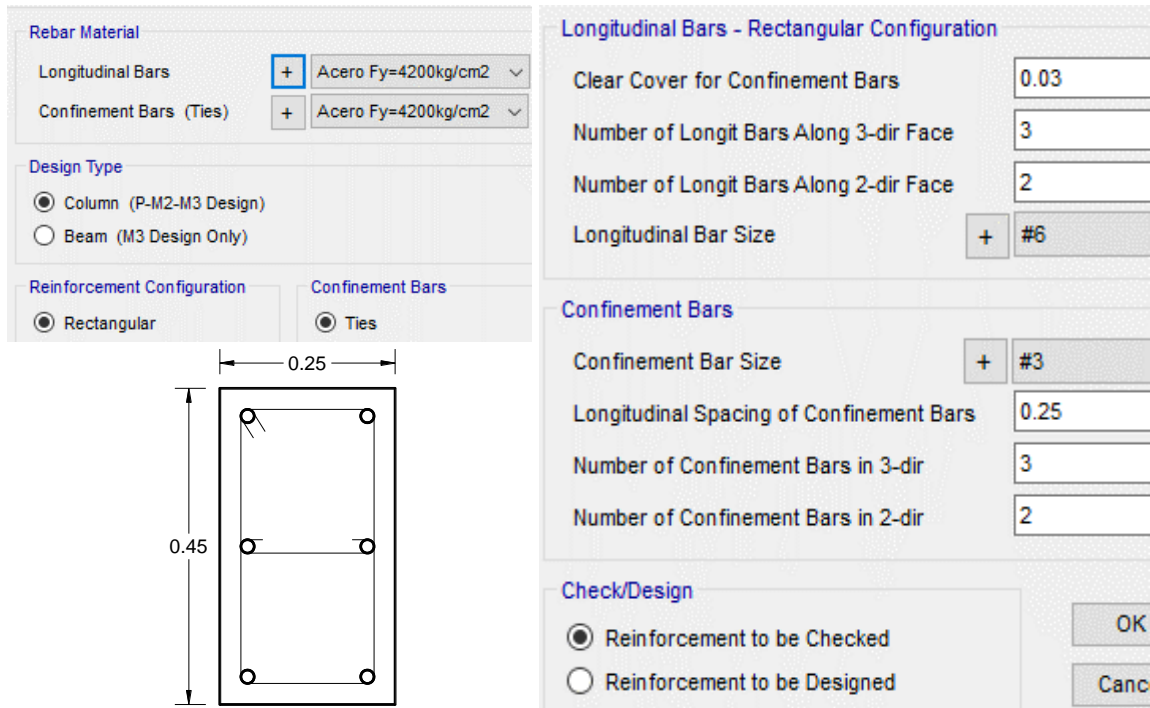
Configuración del refuerzo de la columna. Fuente: Propia.
